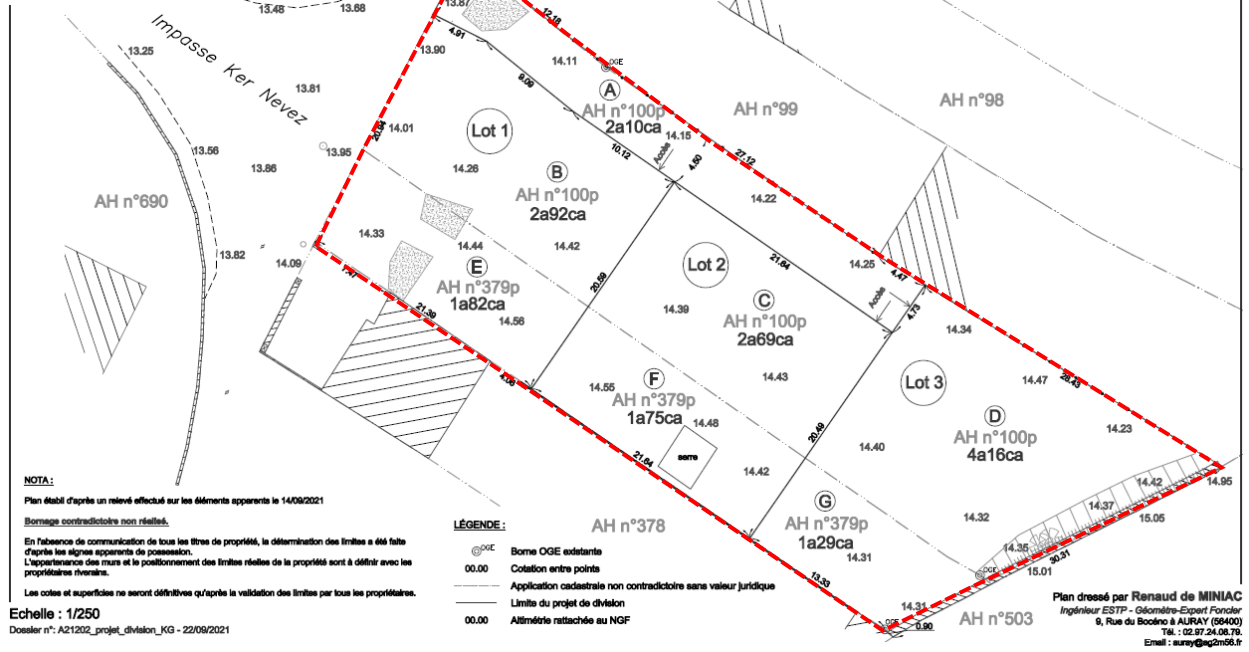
Extrait du plan masse du projet de division (AG2M, septembre 2021)
